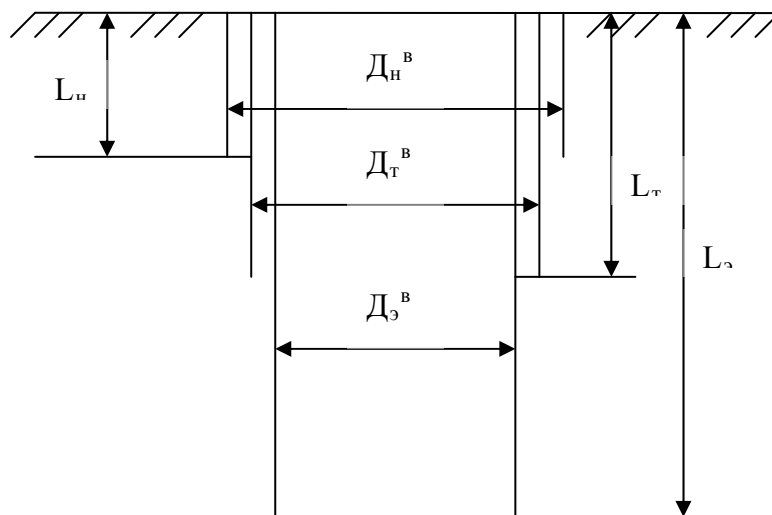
Схема конструкции ствола скважины ударно-канатного бурения
